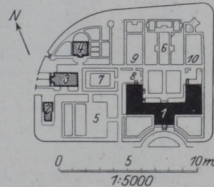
Bergedorf, Krankenhaus für 75 Betten. 1 Hauptgebäude. 2 Leichenhalle. 3 Waschhaus. 4 Wohnhaus. 5 Wäschetrockenplatz. 6 Schwesterngarten. 7 und 8 Garten für ansteckende Kranke. 9 Männergarten. 10 Frauengarten.
